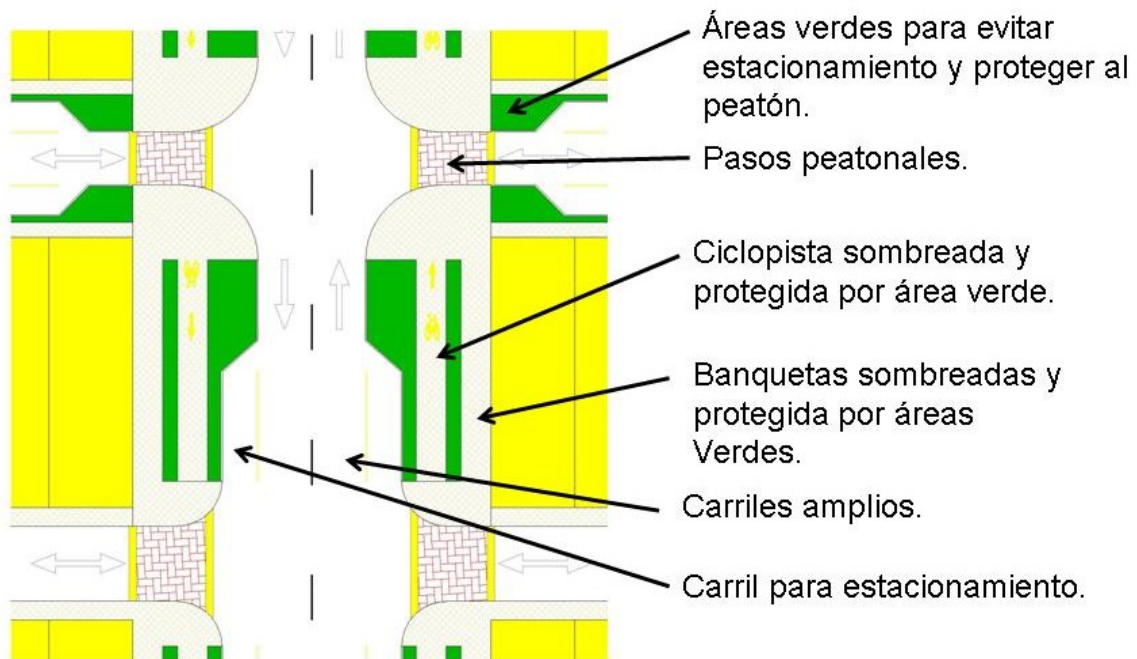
Detalle De Vialidad En El Fraccionamiento Buenavista
